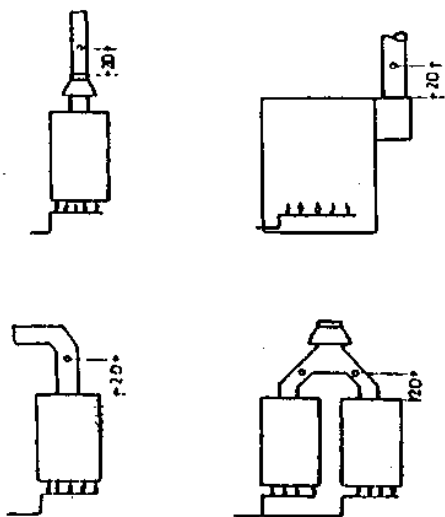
Расположение измерительных отверстий для газотопливных установок с горелками без воздухоподушки.
